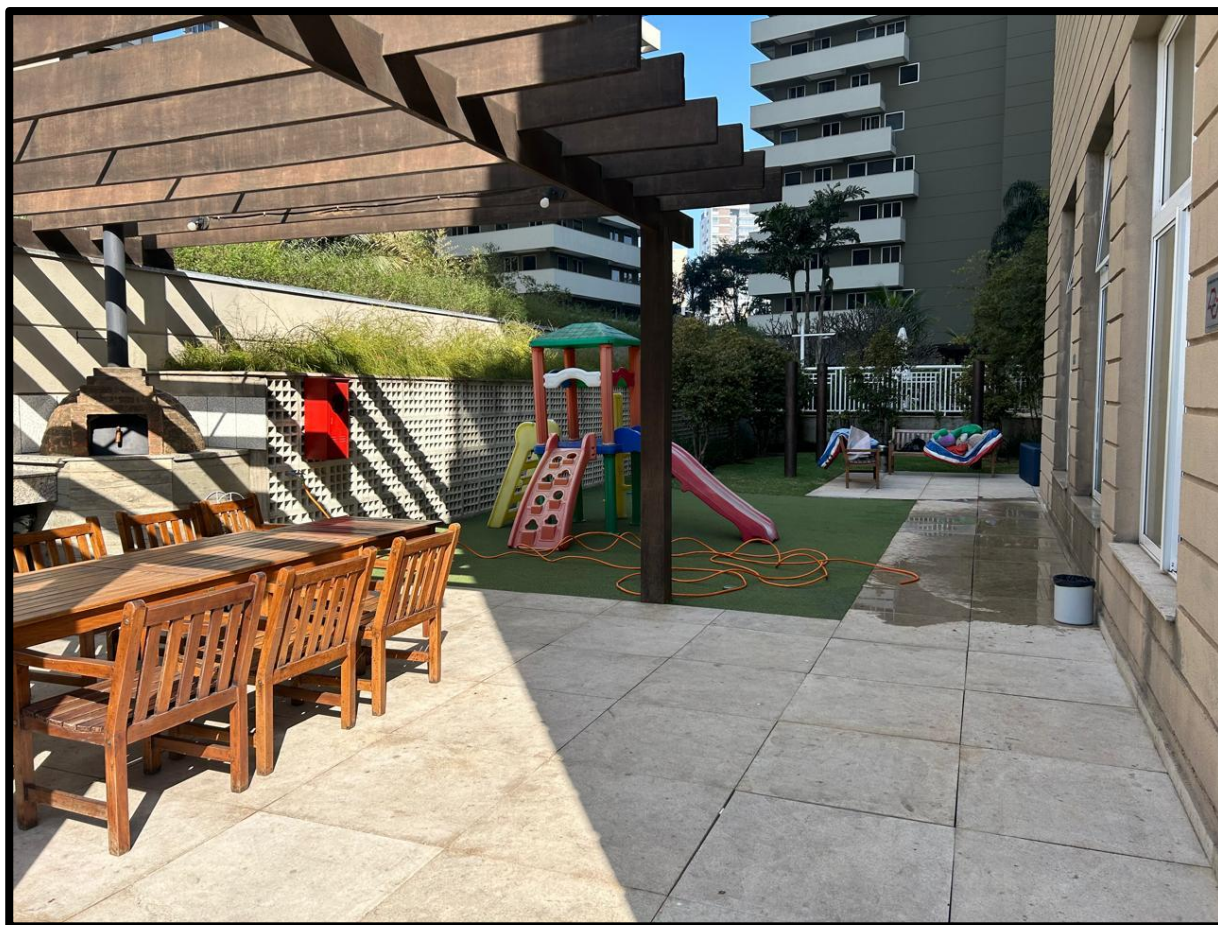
Vista da área destinada ao playground e área gourmet.
